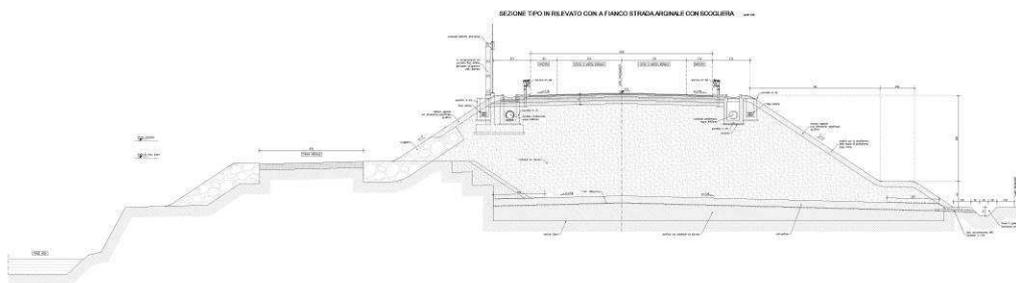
Sezione tipo in rilevato in affiancamento all'alveo dell'Adda
